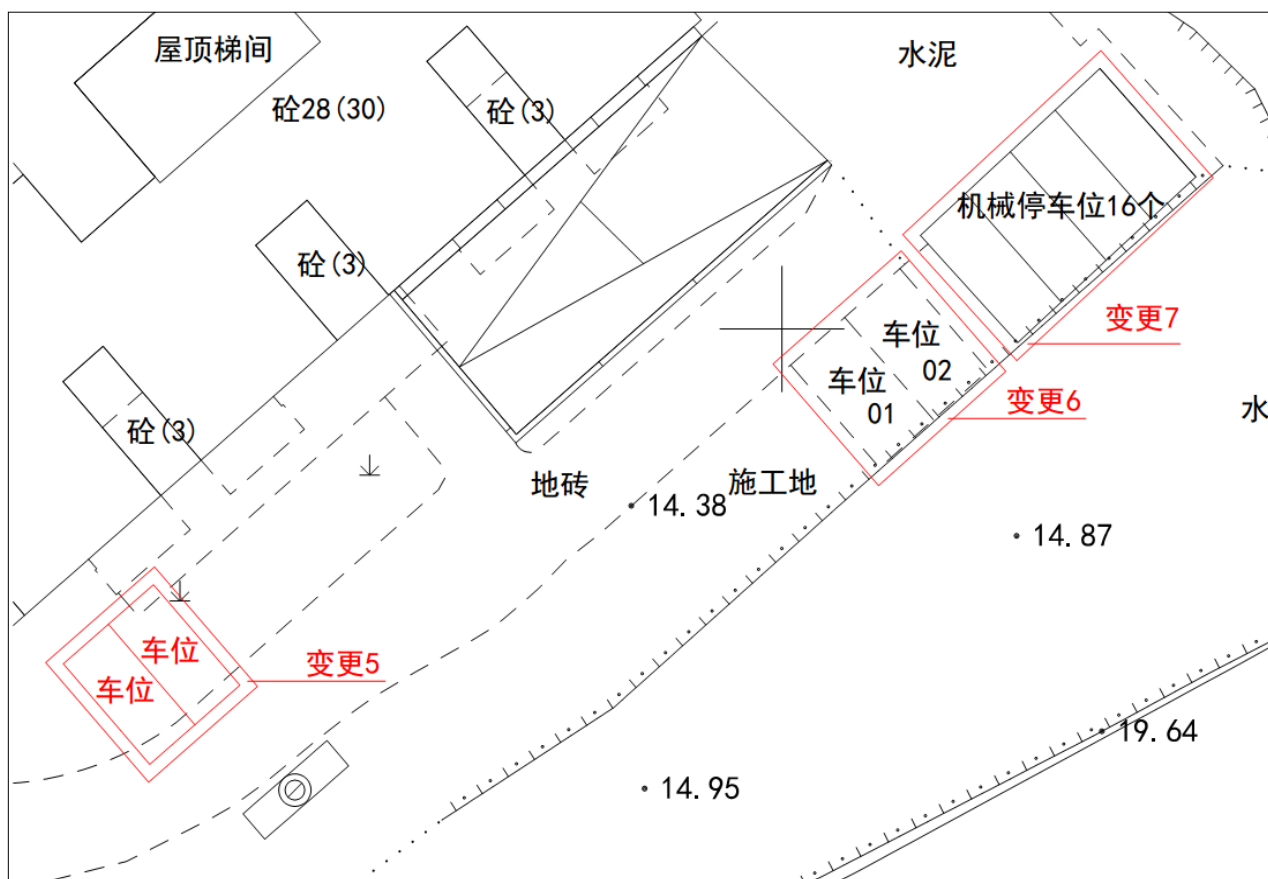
竣工总平面图与规划许可不一致对照示意图局部放大图
